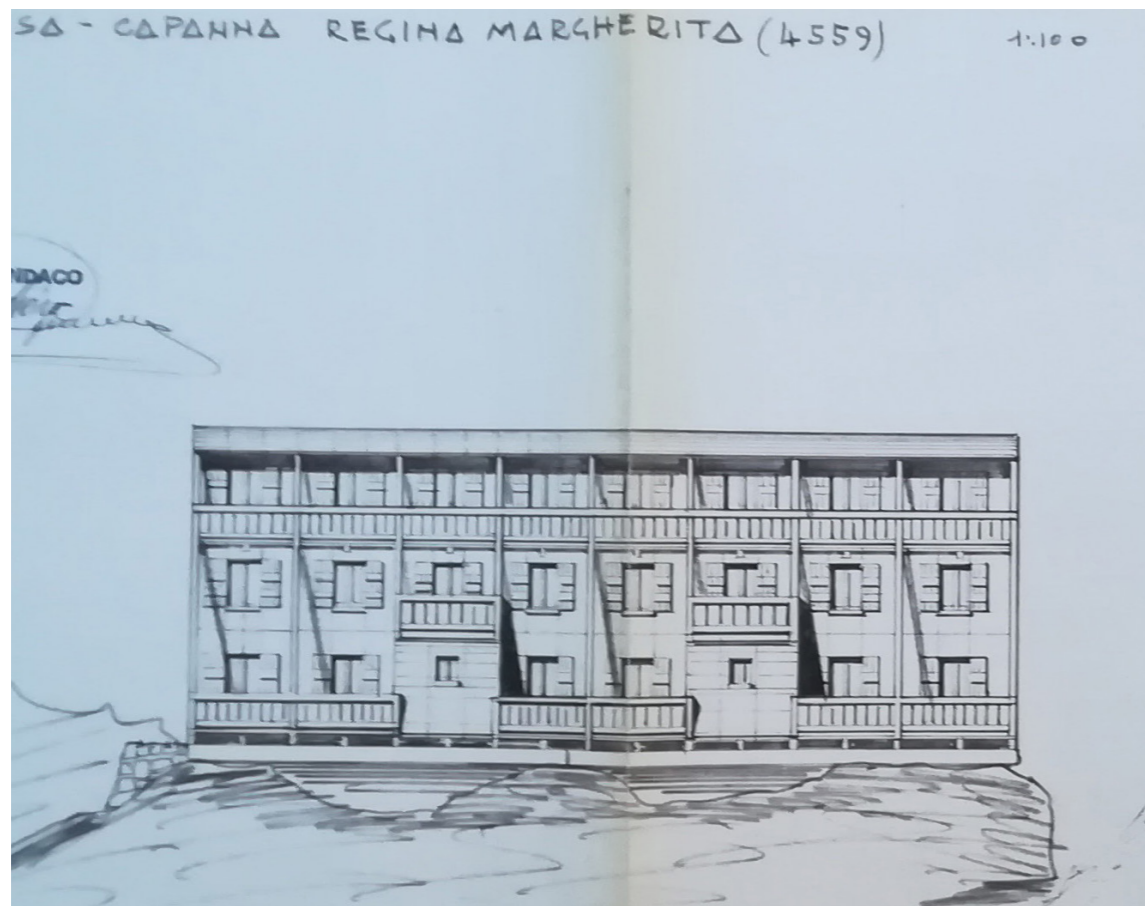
Prospetto sud-est progetto originale del 1977 redatto dallo studio del geometra Carlo Milone.
